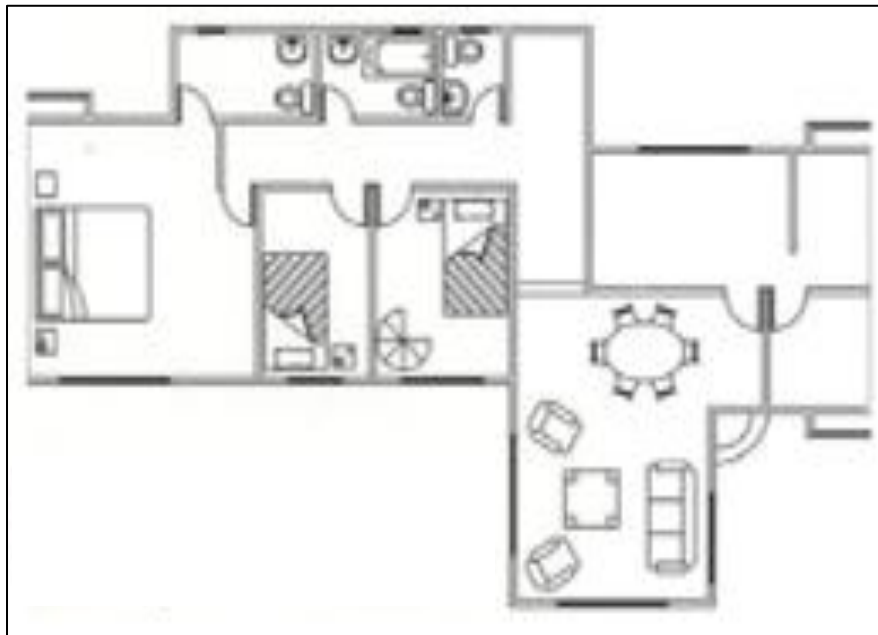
Dibujo en planta para iniciar el trazo de la maqueta
